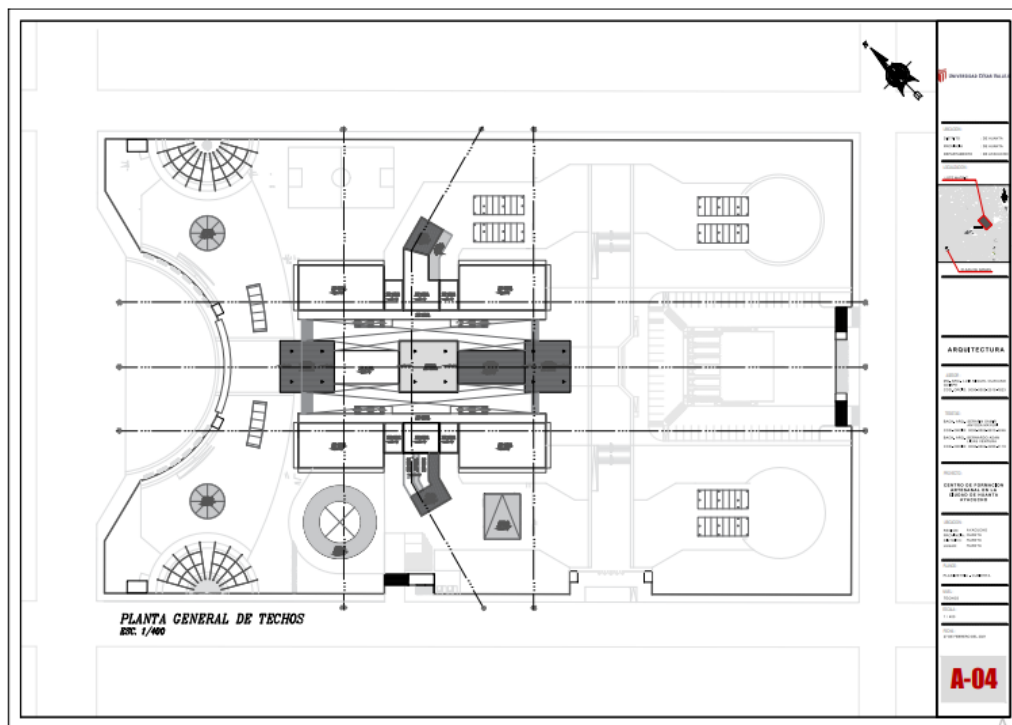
Planimetría general de los techos y cubierta escala 1/400.
